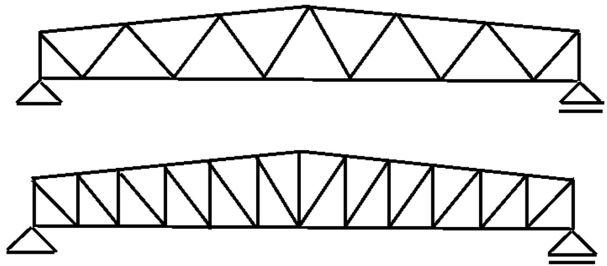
Fachwerkträger mit Satteldach-Trapezform
